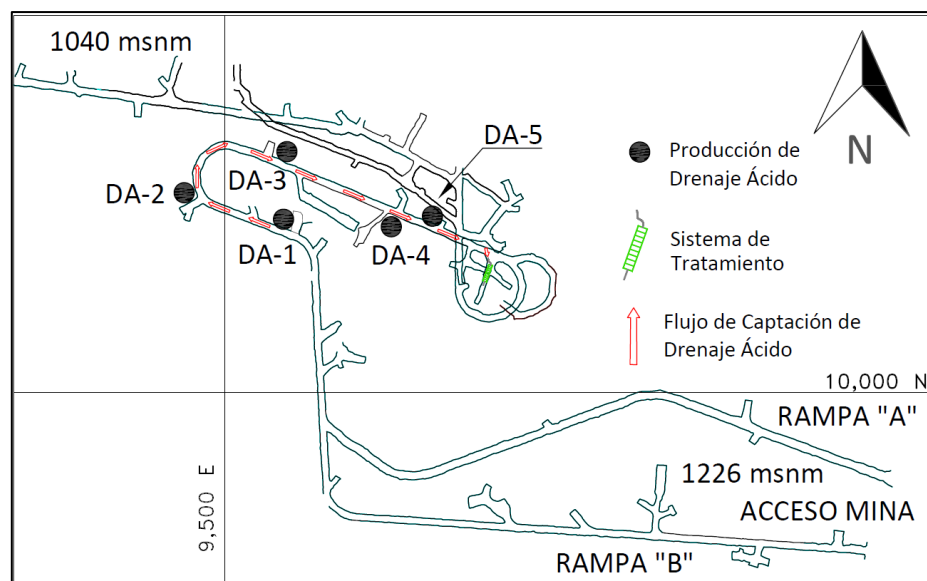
Plano en planta que muestra la conducción del agua desde los sitios en donde se genera hasta el crucero donde es posible instalar un sistema de tratamiento.
